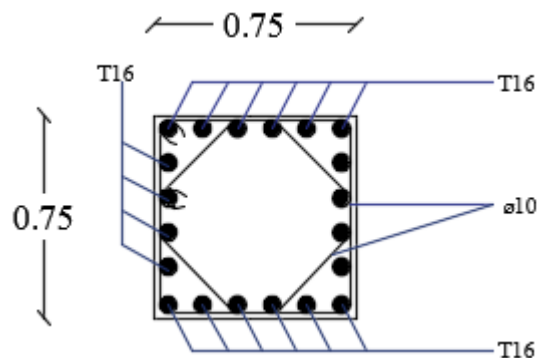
Ferrailage des poteaux sous-sols bloc A1 & A2
